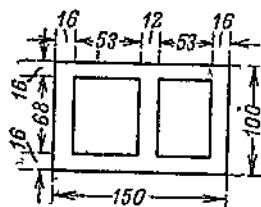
Блоки для заполнения между металлическими или железобетонными балками.
